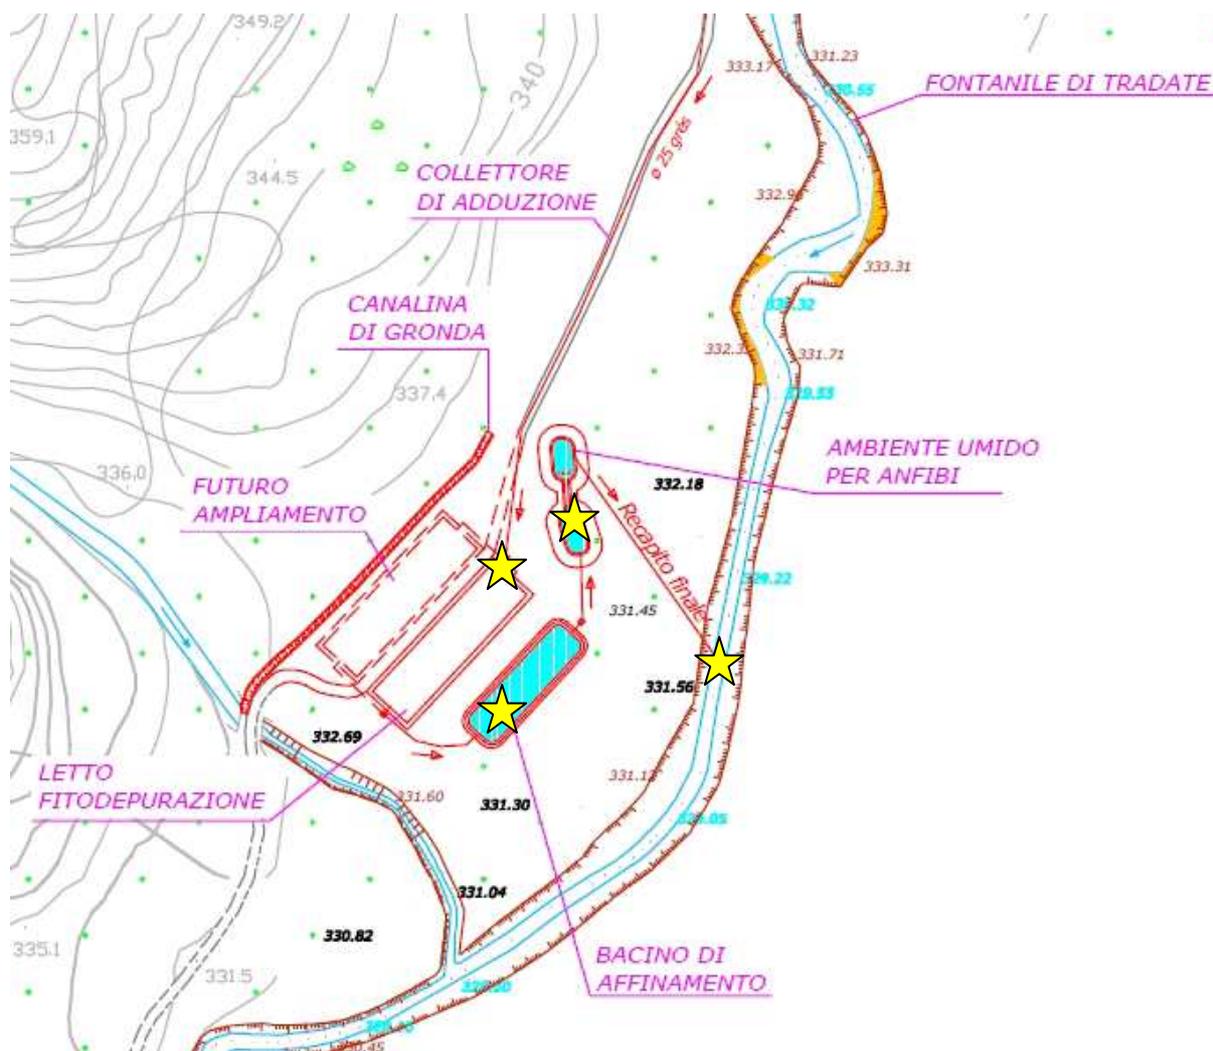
Planimetria dell’impianto di fitodepurazione sito in località Pianbosco; i quattro punti di campionamento sono indicati dalle stelle gialle.
